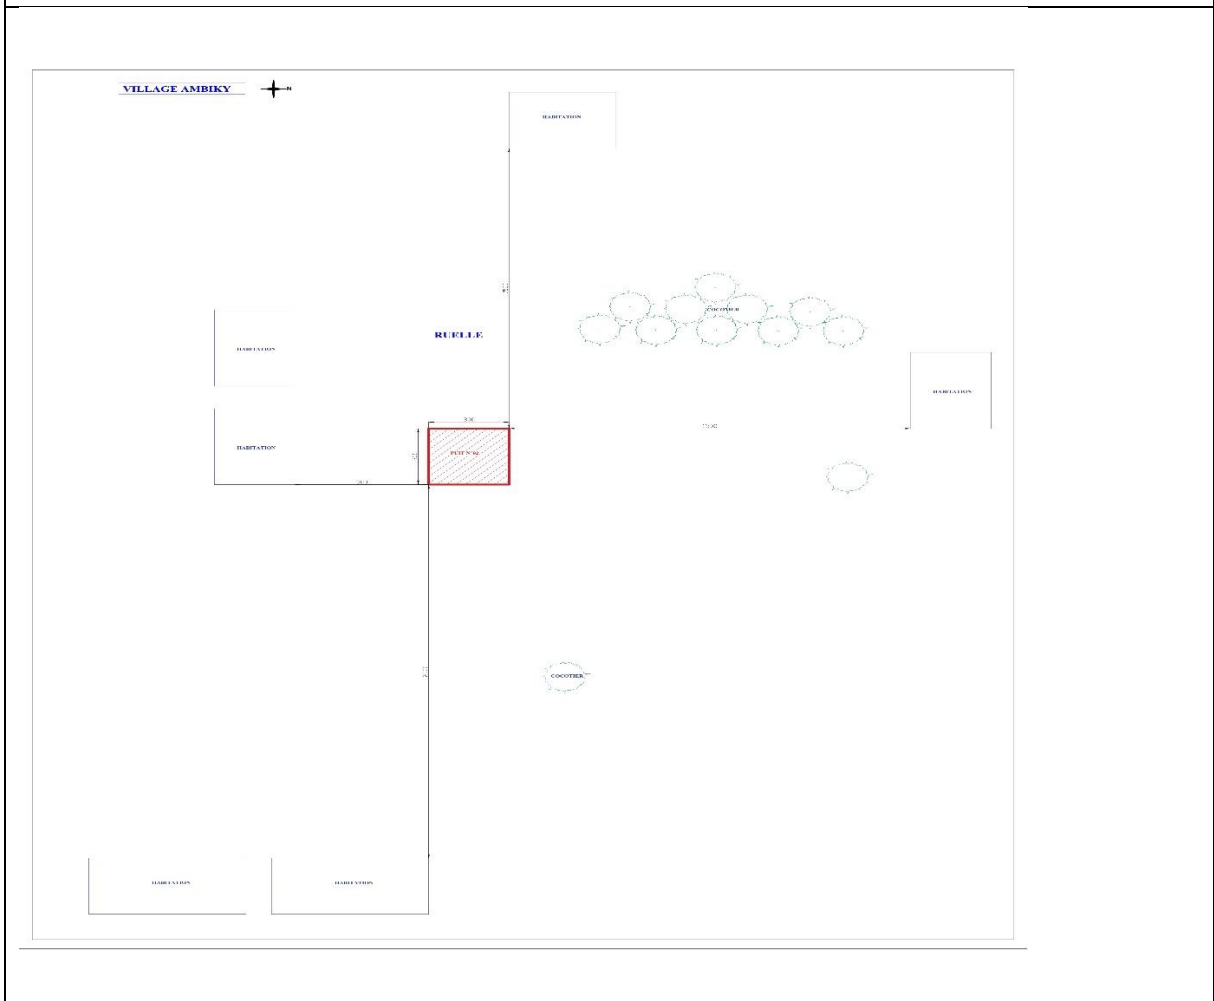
Plan d'occupation du sol dans le village d'Ambiky
